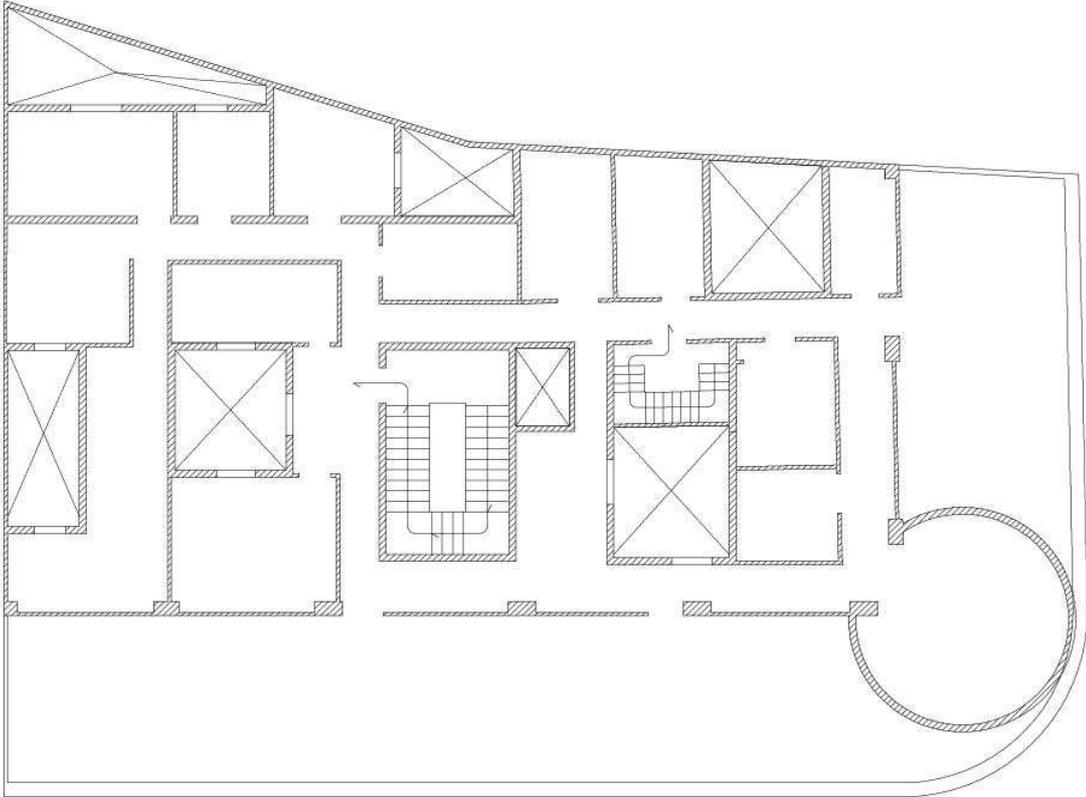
Levantamiento CAD Plantas desvanes Edificio Niederleytner. Fuente: Elaboración propia.
